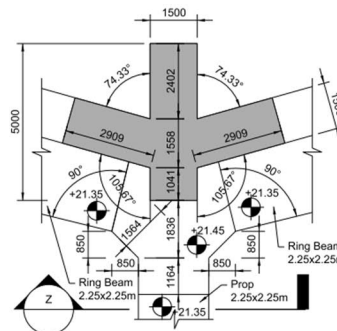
Planta del contrafuerte con su forma de pie de pájaro.
